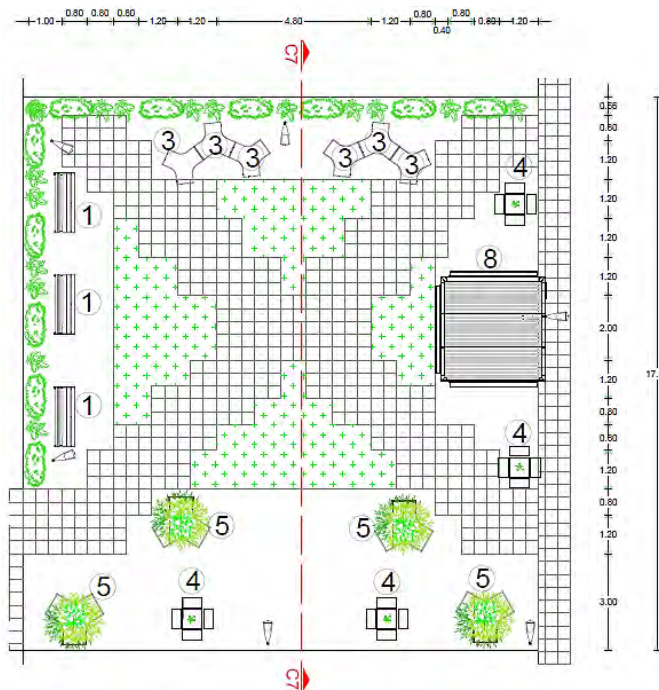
Planta arquitectónica de la plaza 14. Se observa la ubicación del mobiliario y el juego con el pavimento, delimitando pequeñas áreas de convivencia generando niveles de privacidad.
